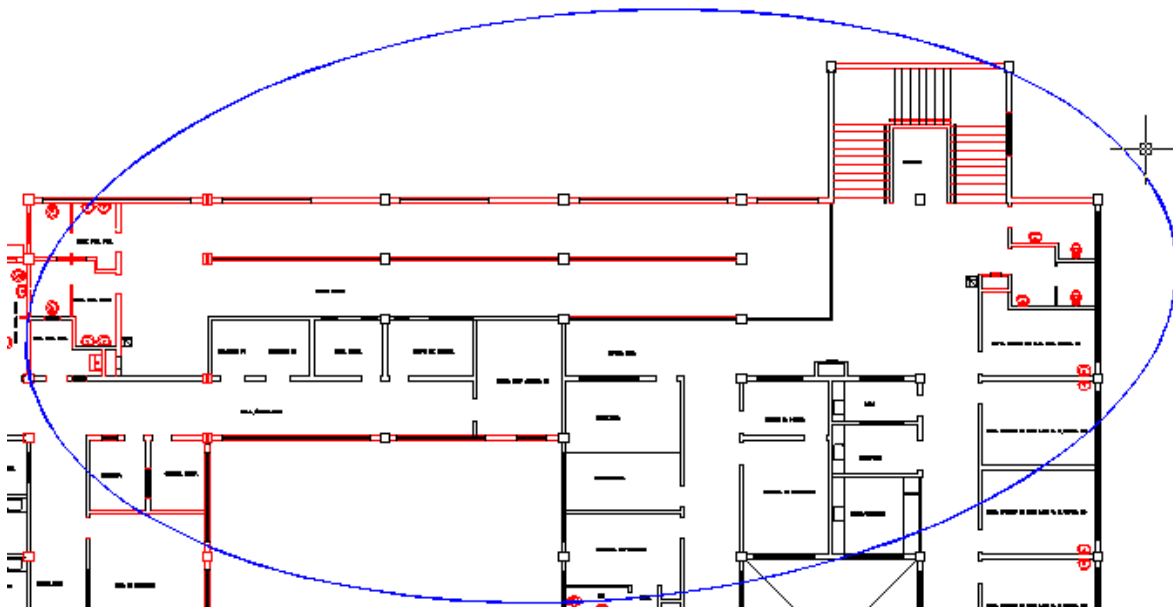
Planta baixa do pavimento térreo do atendimento ambulatorial, área de pesquisa.
